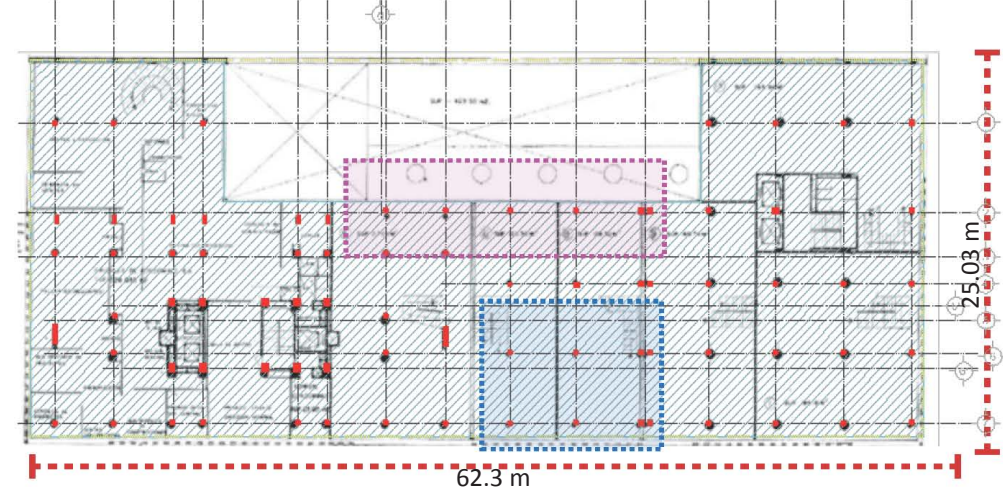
Plano de Planta Mezzanine. Modificado para fines académicos. En éste plano se marca con rojo la estructura y en sombreado cian las áreas ocupadas Fuente: creación propia
